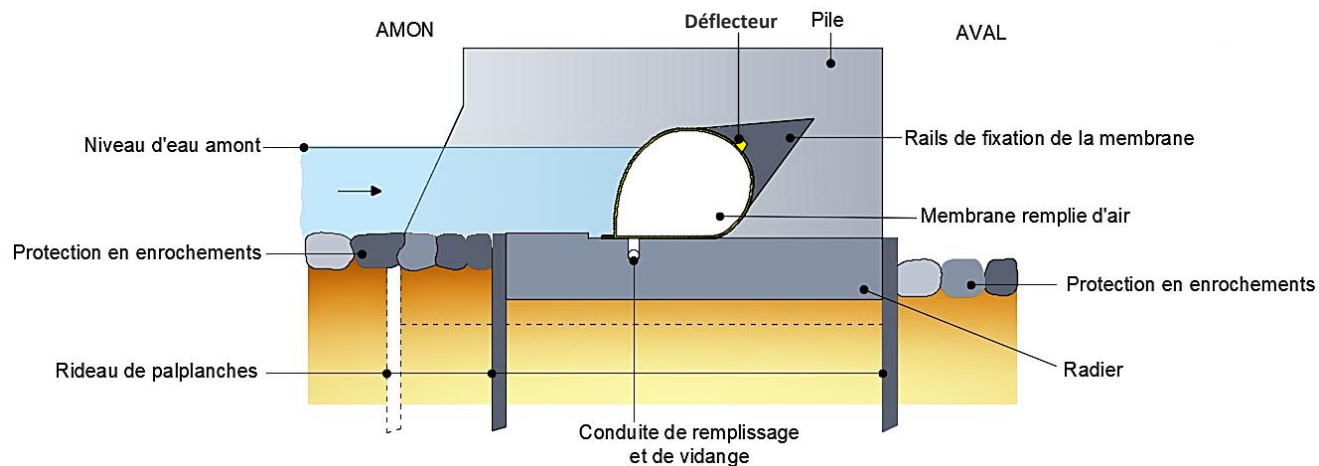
Schéma d'une coupe transversale du barrage gonflable
